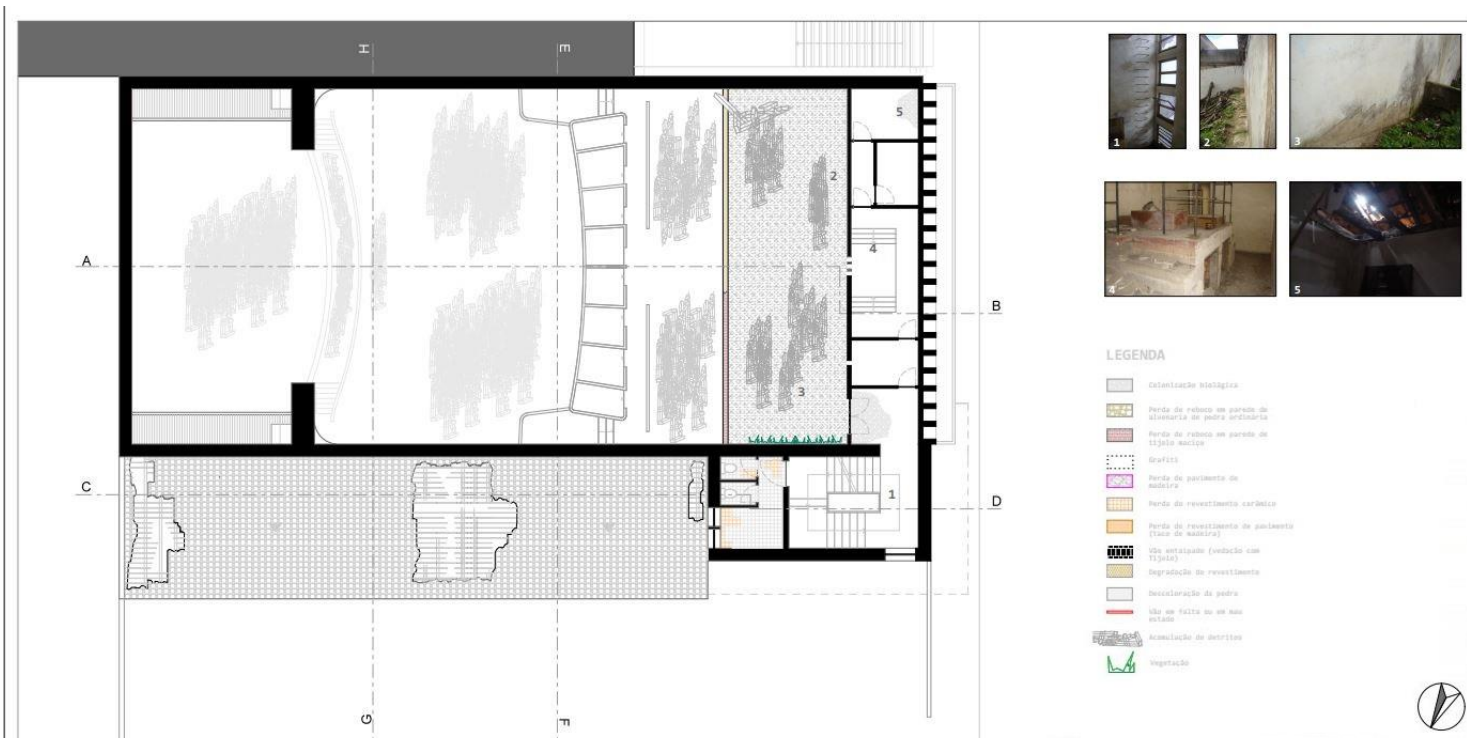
Estado Conservação Planta Piso 2, Pedro Santos 2017
